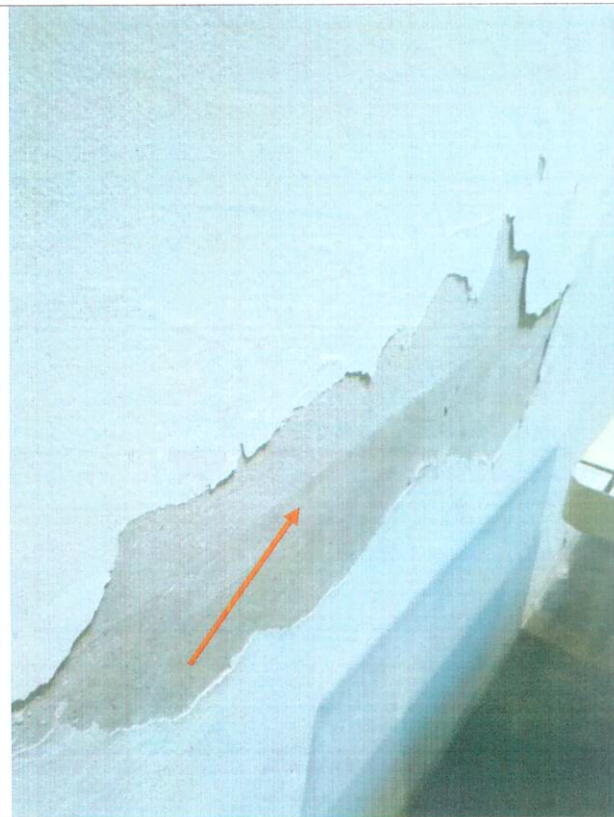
detalhe da parede da fachada do embarque e desembarque - descascamento da tinta – fissura externa. Nota-se a diferença de material construtivo no fechamento da antiga janela.
